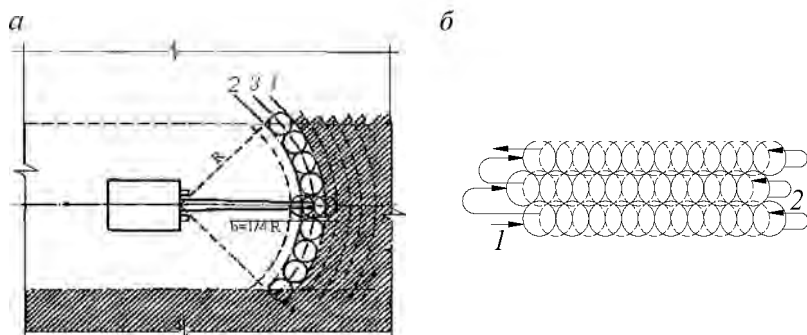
Схема уплотнения грунтовых оснований с перекрытием следов:
